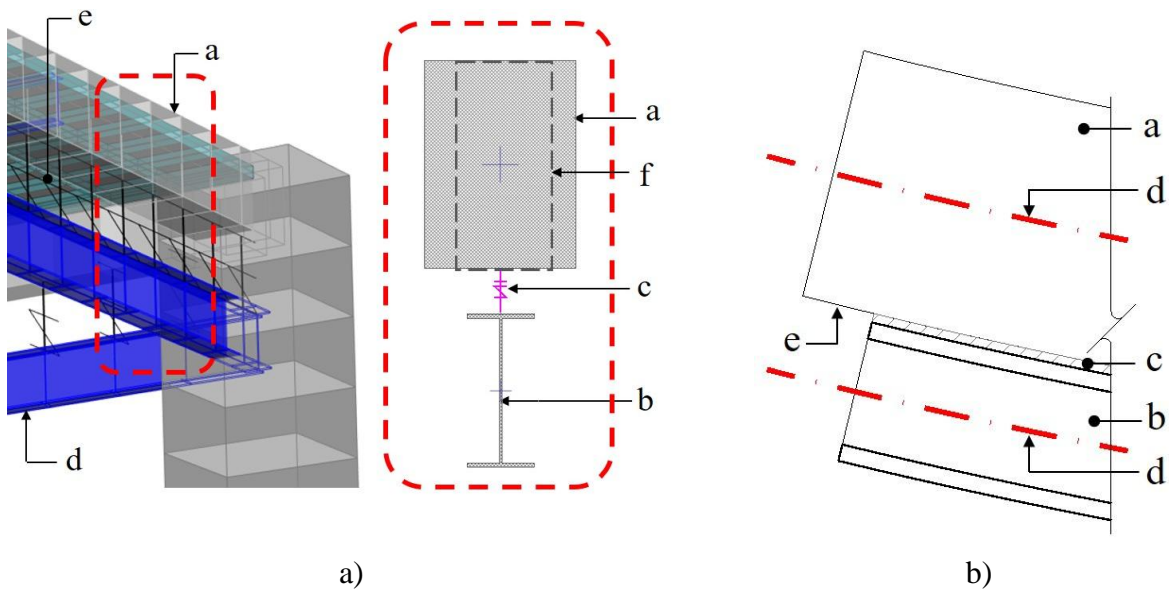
Vigas principais de contato; a) modelo estrutural com vigas de contato com lacunas; b) detalhe de viga de contato; onde: a = viga fissurada de concreto armado, b = viga de aço, c = elemento lacuna de contato, d = eixo neutro, e = deslizamento entre elementos estruturais, f = seção transformada de viga de concreto considerada de acordo com a diminuição do momento de inércia.
